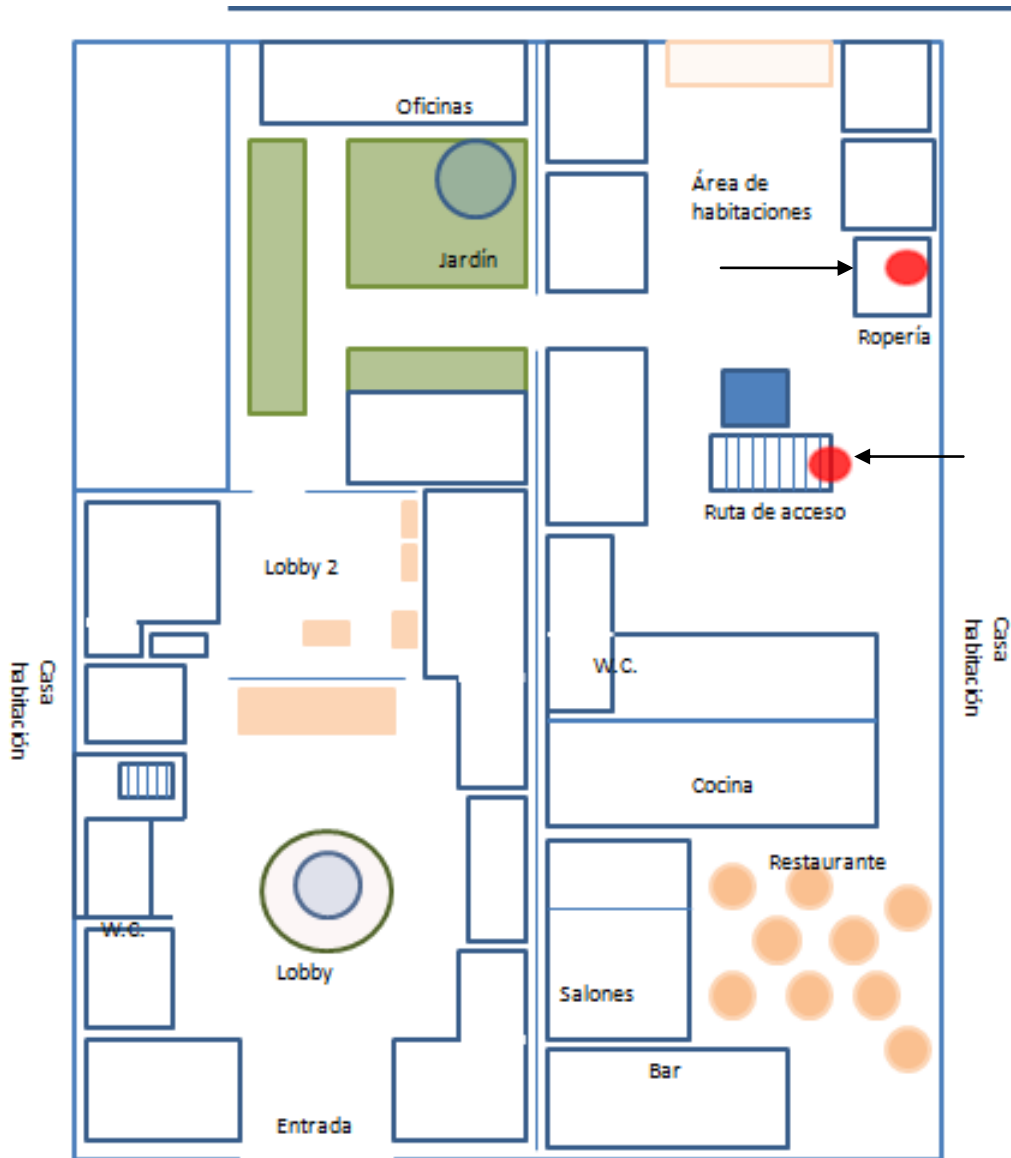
Propuesta de ubicación de detectores en la planta baja, situados en ruta de acceso a escaleras y en ropería
